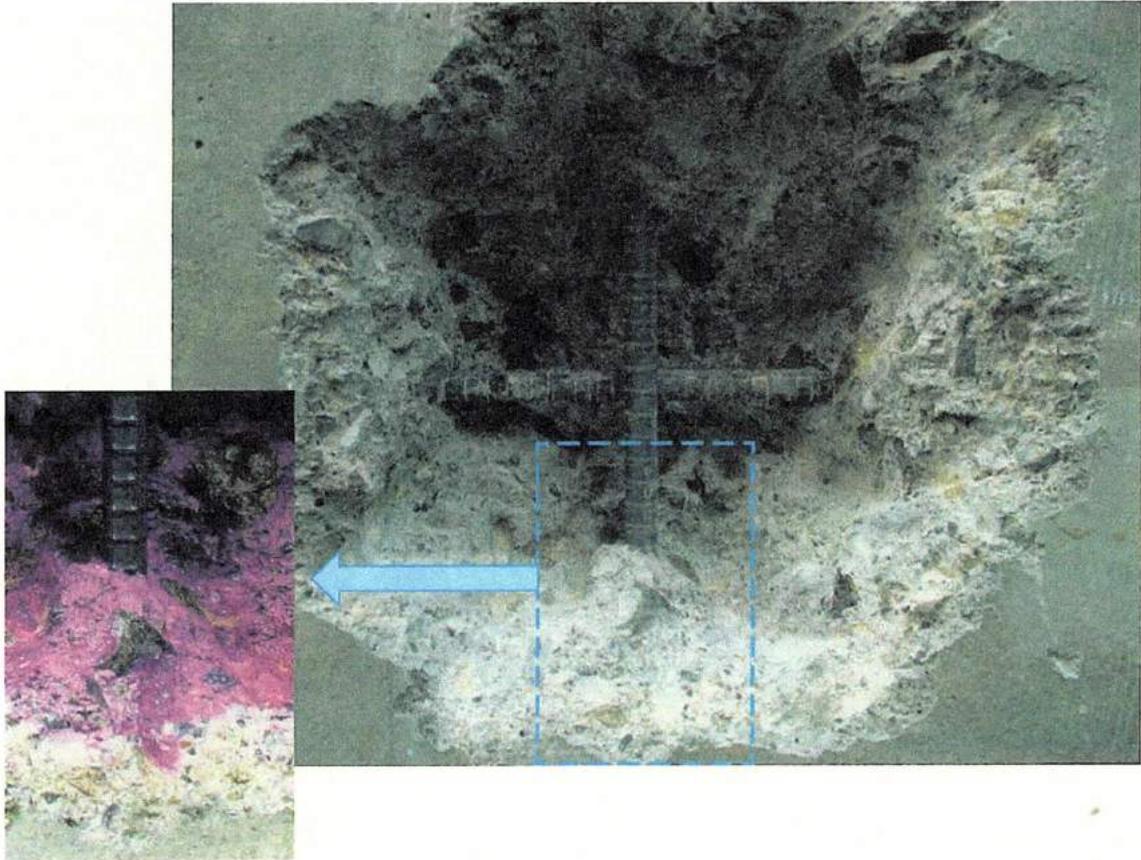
調査点A(屋外, ひび割れ無し)の鉄筋の状況と中性化深さ調査の状況
